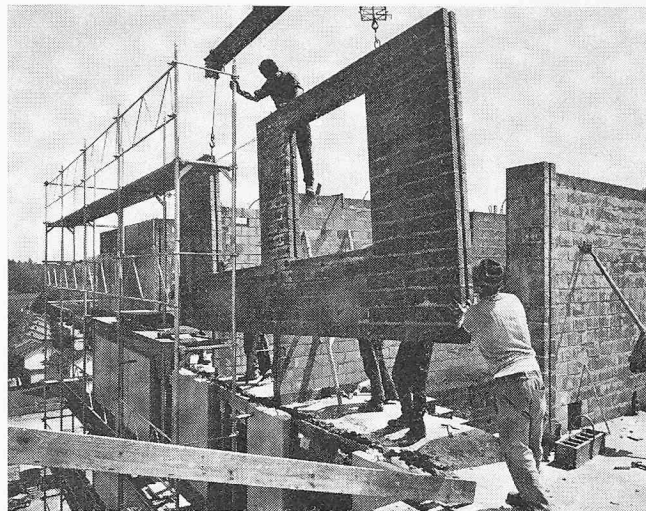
Montage eines Fassadenelementes im 17. Stock und Ansicht der Betonplatten des 16. Stockes
